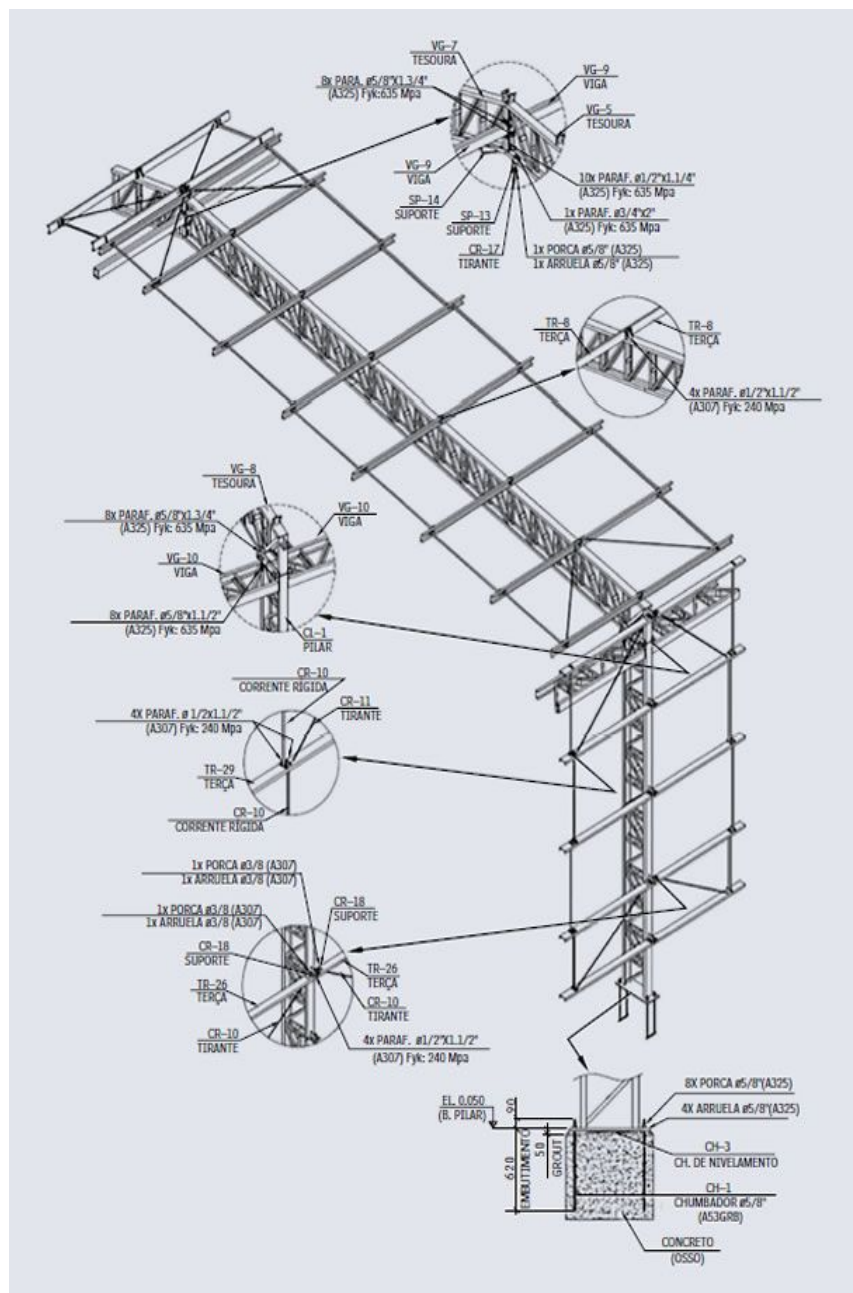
Detalhe isométrico para montagem do pórtico padrão.
